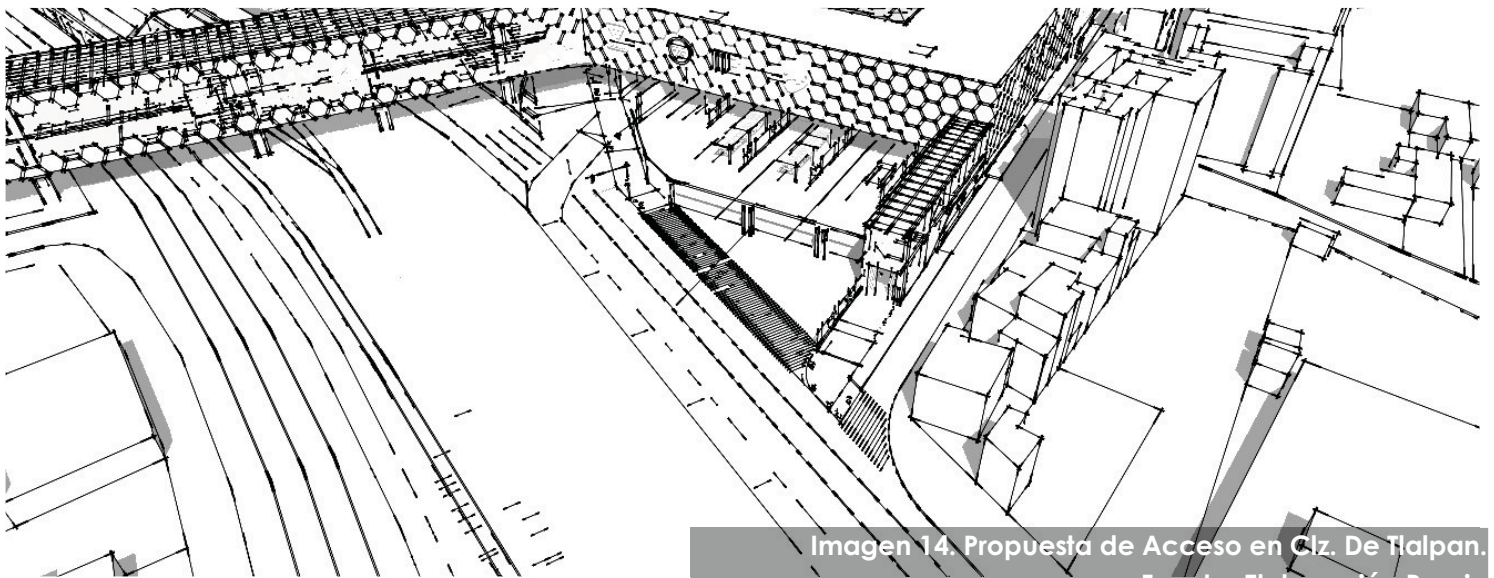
Propuesta de Acceso en Clz. De Tlalpan.
